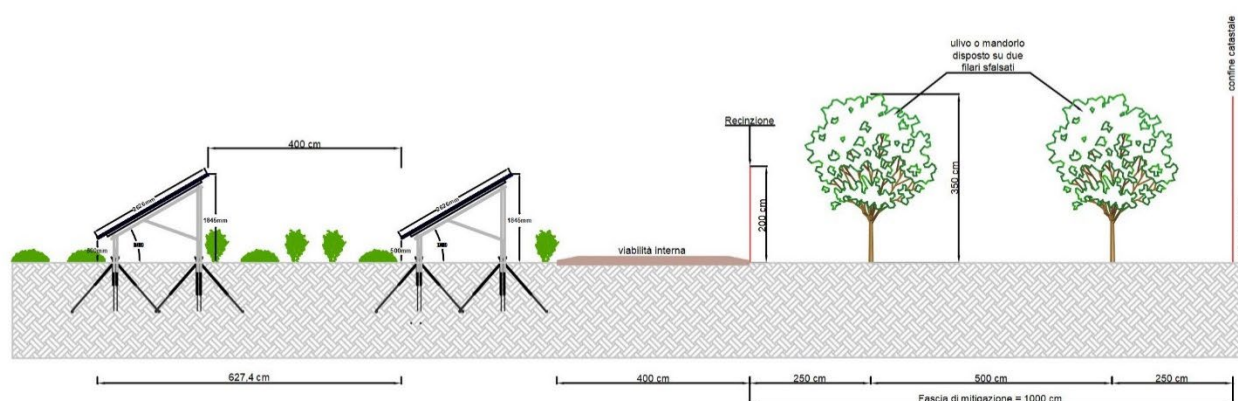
Area di mitigazione pianta e sezione trasversale e in pianta
